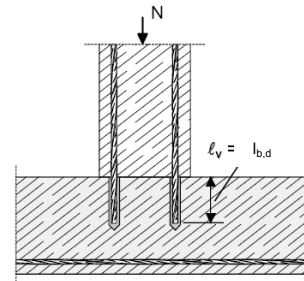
Recouvrement d'armatures pour la liaison de dalles et poutres
